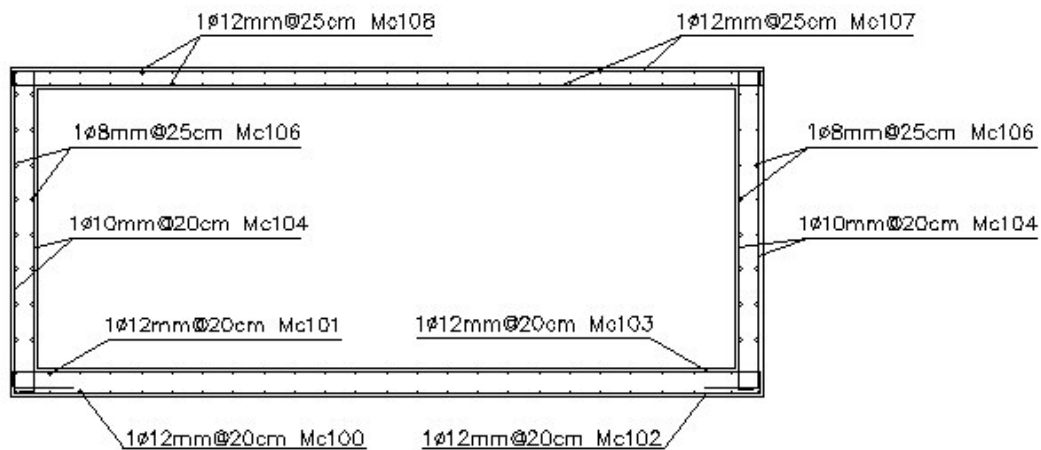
Corte transversal, armado de paredes, losa de fondo y losa de cubierta
